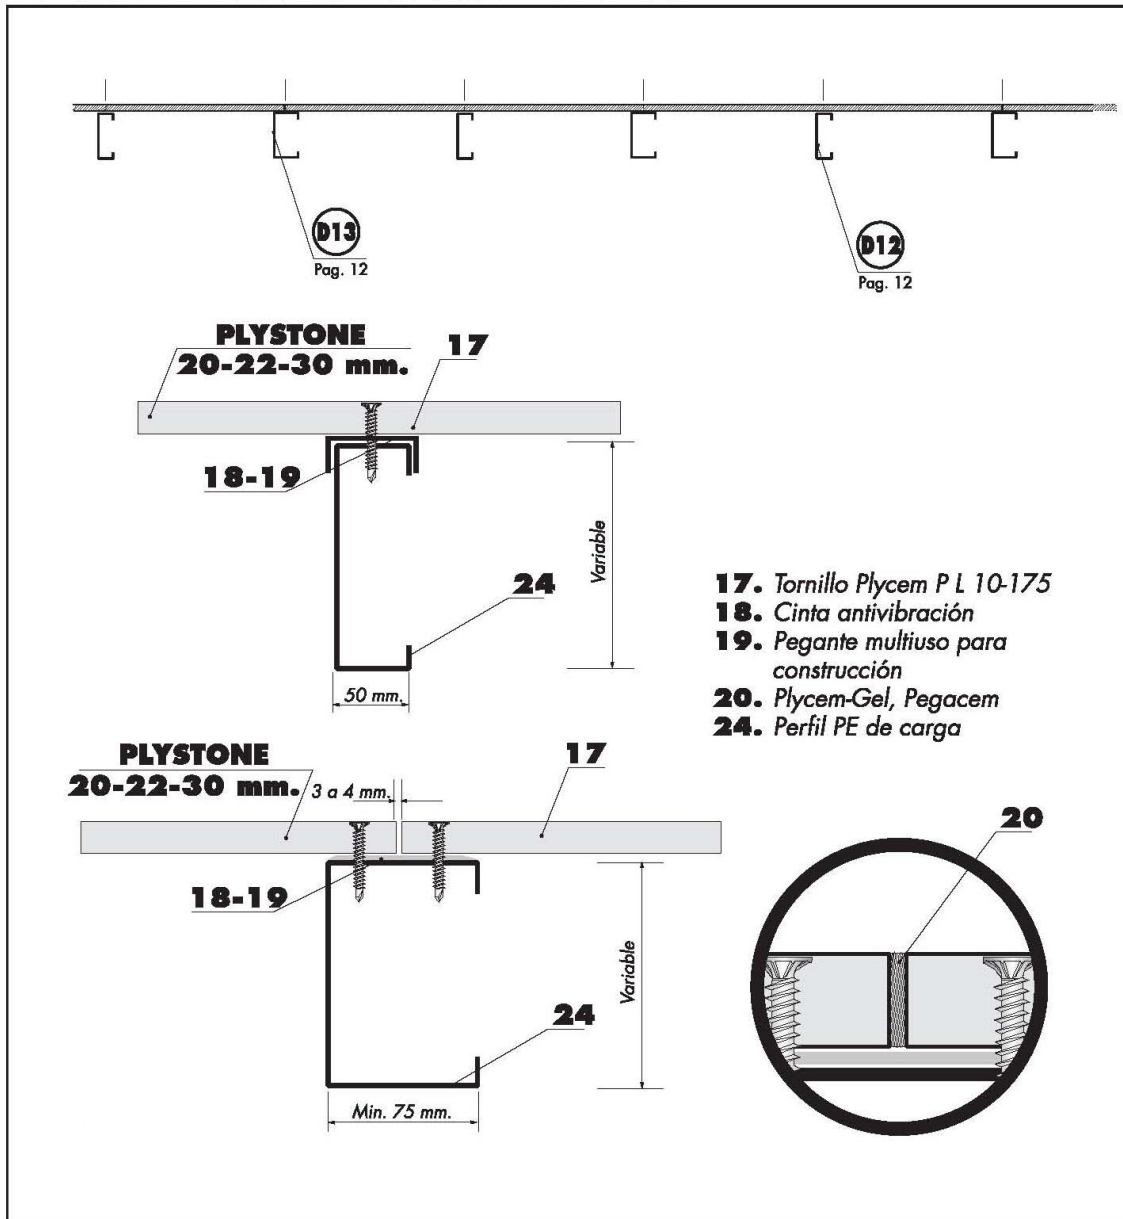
Detalle 4. Forjado. Fijación de lámina Plystone a perfiles [87].
